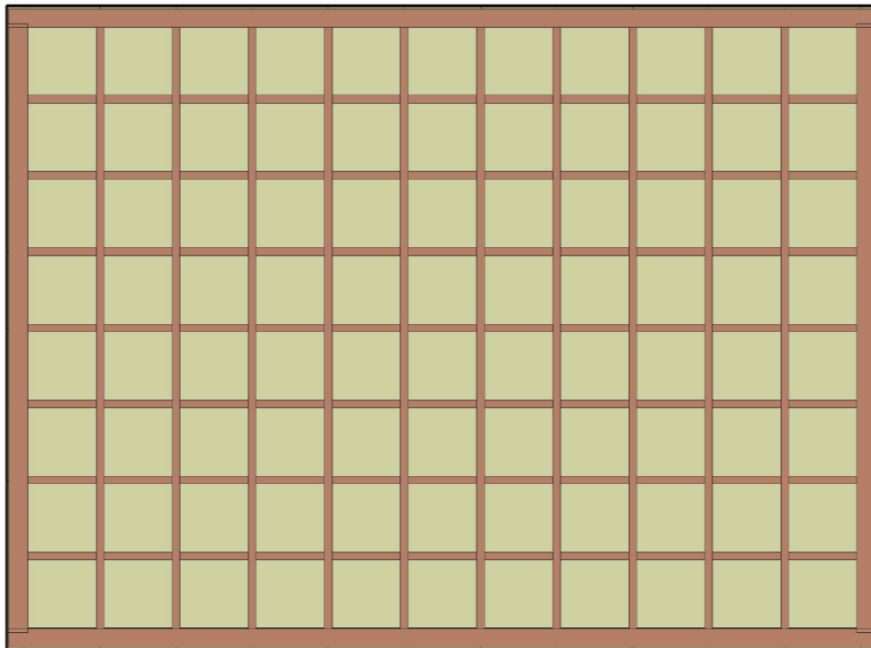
Estrutura da cobertura, eixo das vigas de metro em metro.
